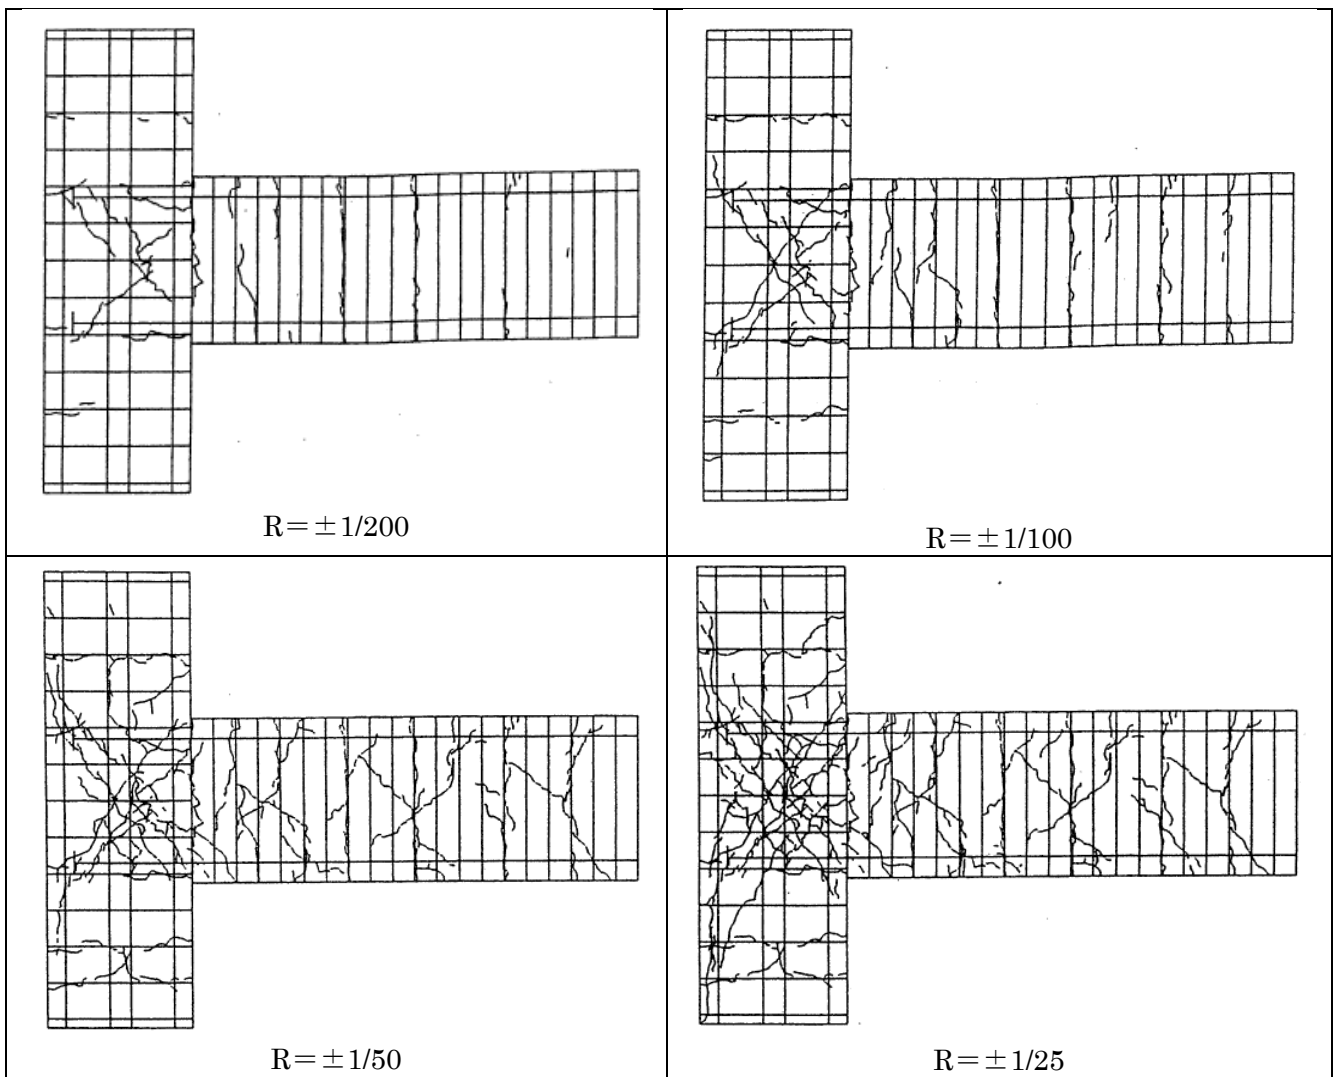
6. 1999No.8 試験体ひび割れ図
